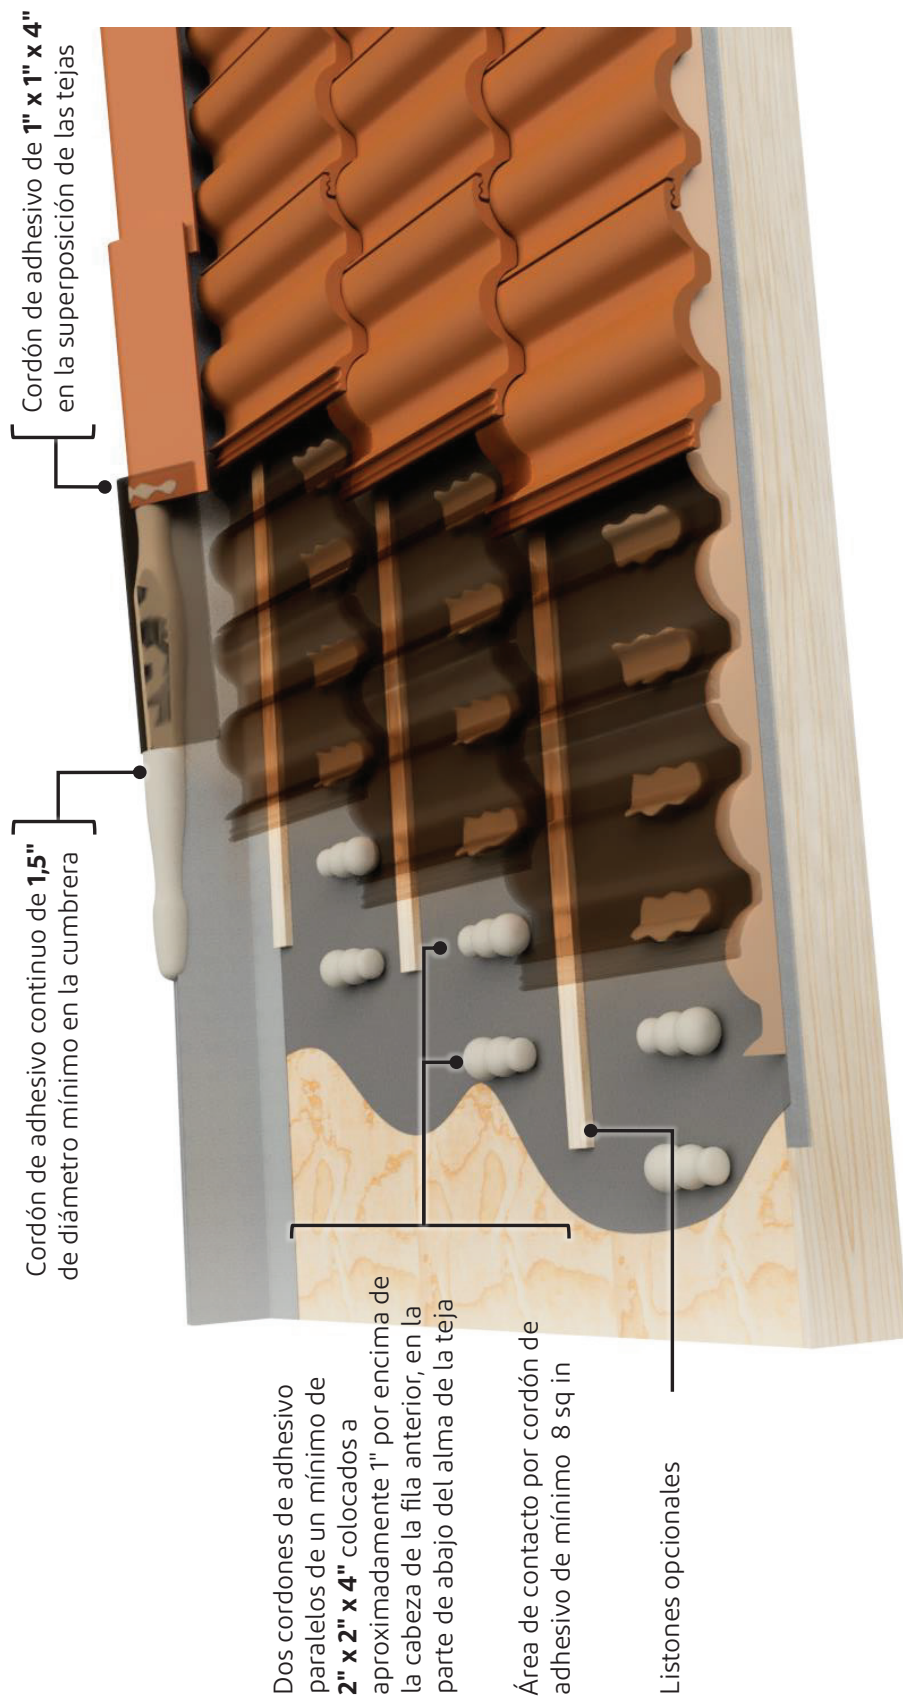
Colocación de adhesivo INTERDEPENDIENTE de perfil alto
